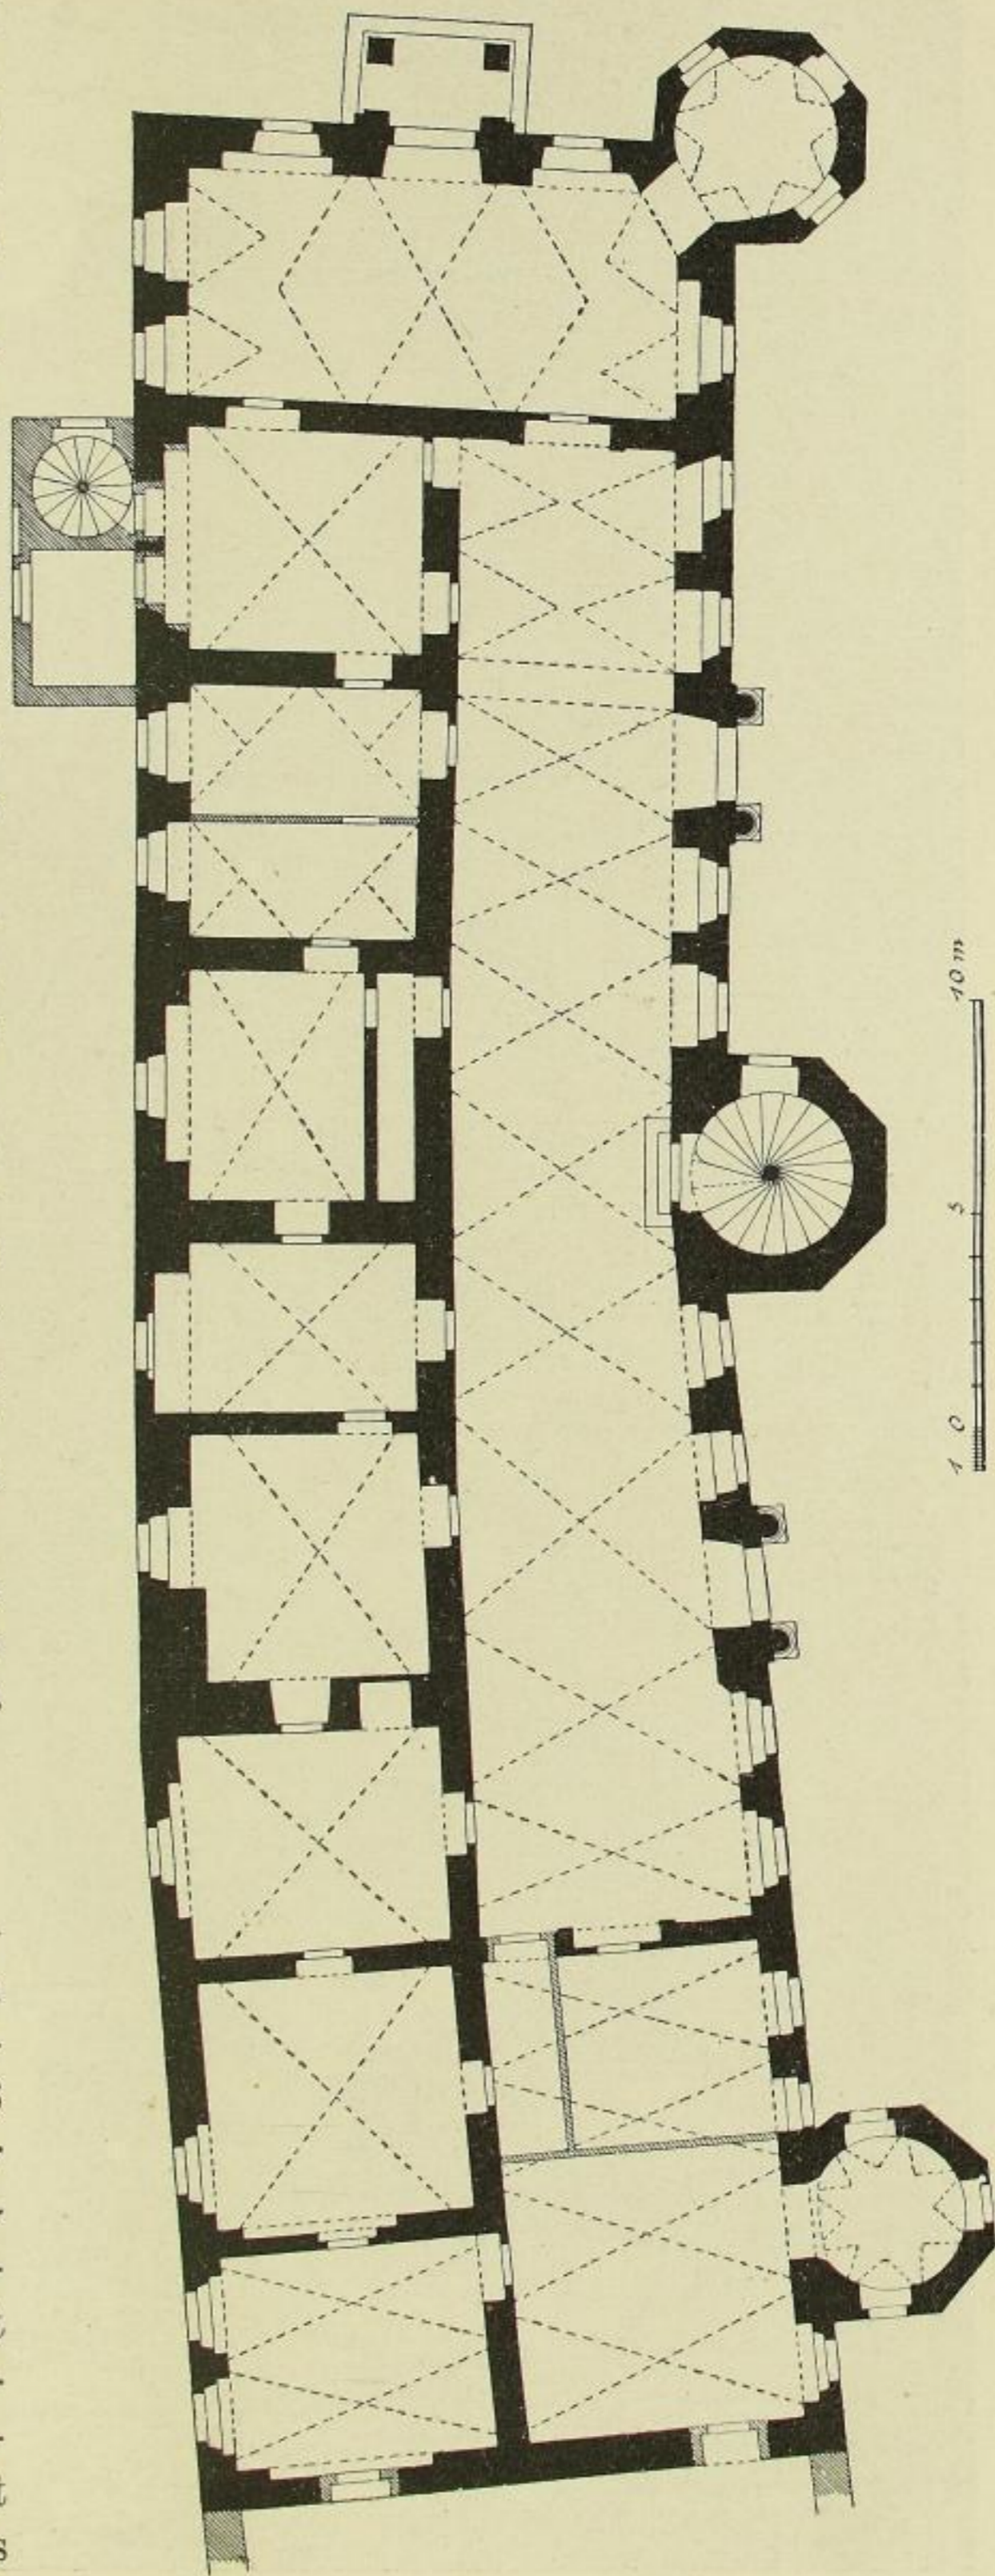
Schloss Hermsdorf, Grundriss des Erdgeschosses.
